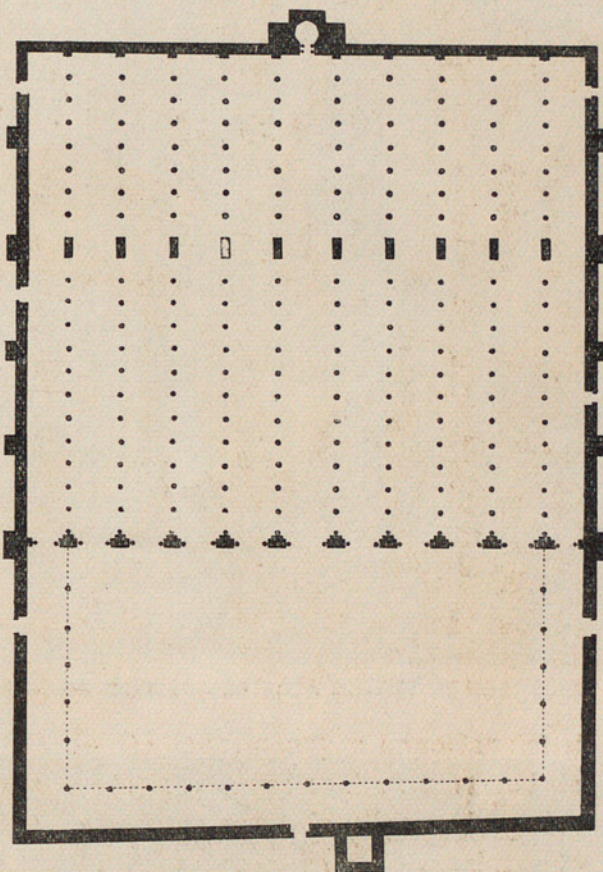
PLANTA DE LA MEZQUITA BAJO ABDERRAHMAN II (SIGLO IX).
